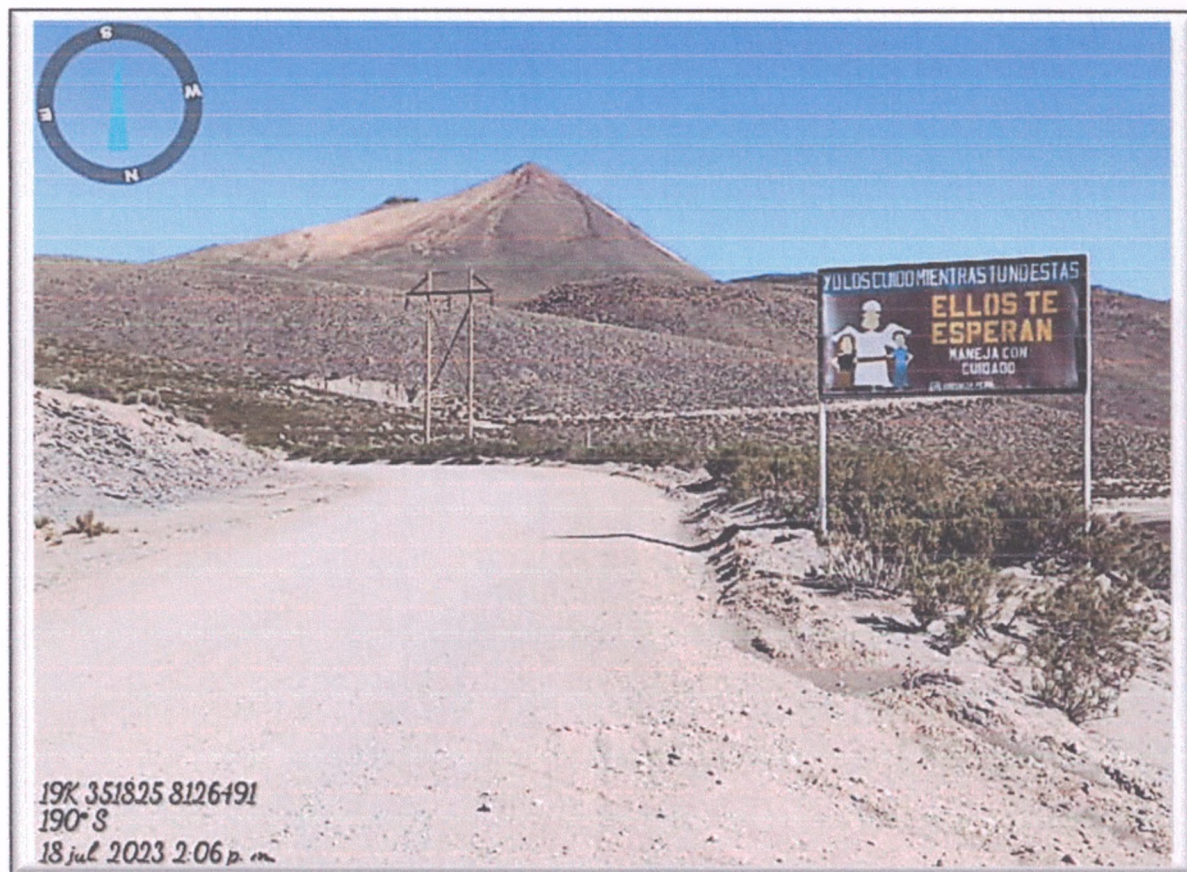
Vista de Plataforma con desgaste por erosión y lluvias de temporada.
